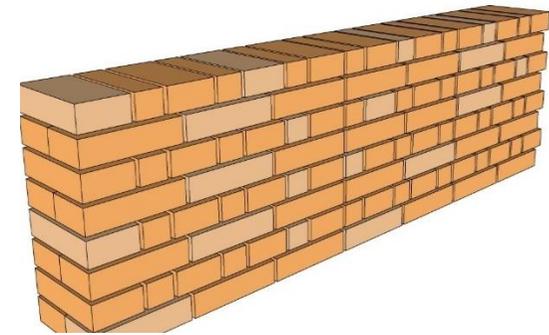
Aparejo tipo hilada compuesta, Fuente: elaboración propia
